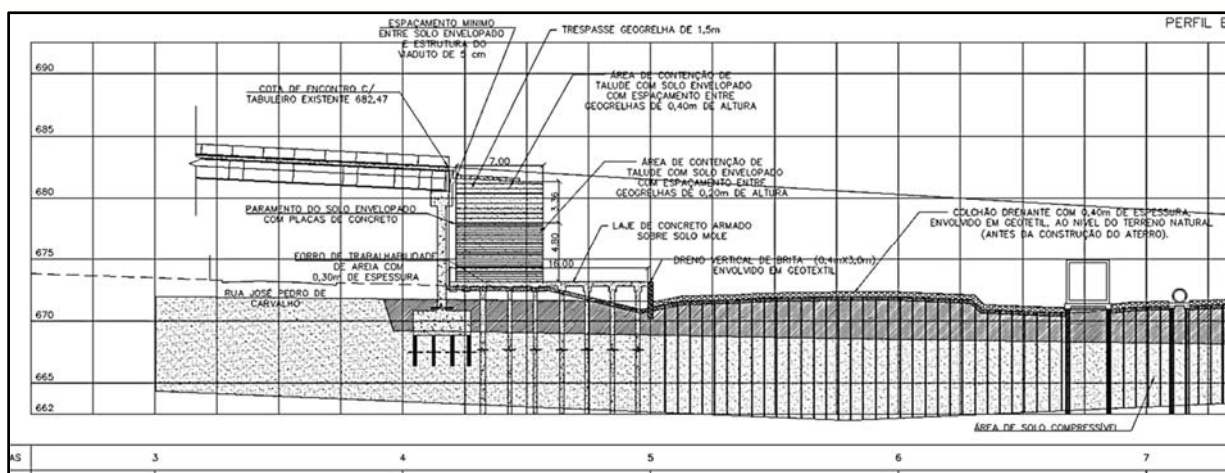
Detalhe do aterro envelopado no encabeçamento do viaduto sobre laje estaqueada. Também disposição dos geodrenos e fundação estaqueada do (BSCC 3,00 X 3,00) m e BSTC vizinho.
